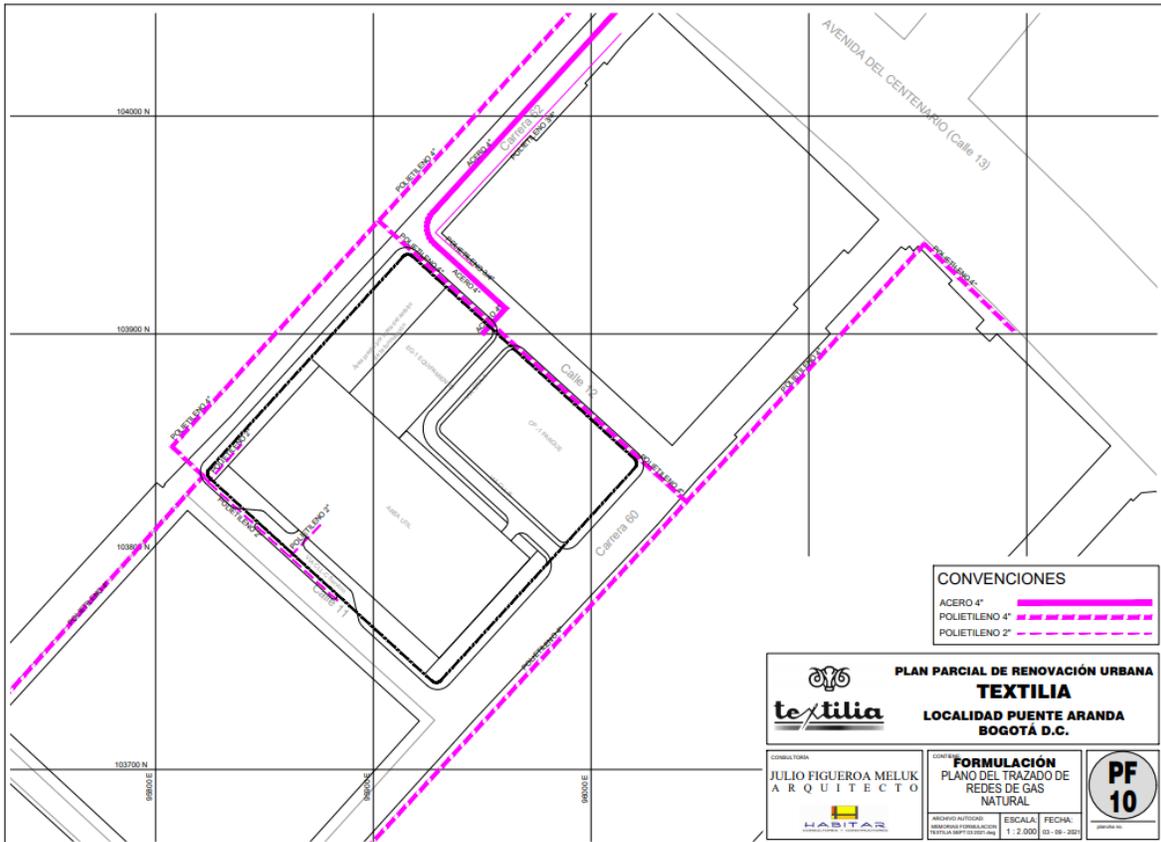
PF10. Trazado de Redes de Gas Natural
